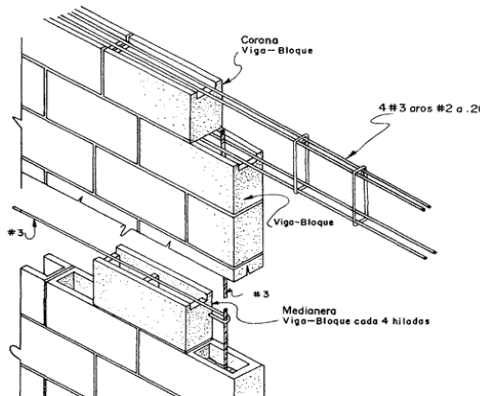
Detalle de colocación de bloques con 1cm de mortero, detalle de acero horizontal con uso de viga-bloque y detalle de viga corona. ([http://www.elconstructorcivil.com/2012\\_05\\_01\\_archive.html](http://www.elconstructorcivil.com/2012_05_01_archive.html))
